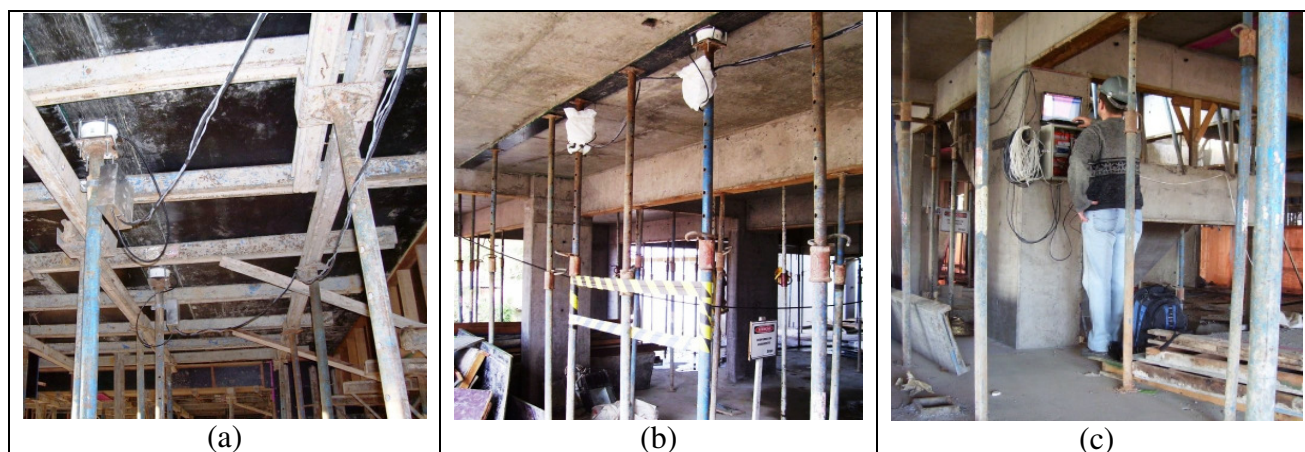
montagem do primeiro ensaio teste. (a) escoras remanescentes instrumentadas posicionadas sob a laje, (b) laje com pontaletes instrumentados e reescoramento em excesso, (c) central de aquisição de dados no pavimento inferior.
